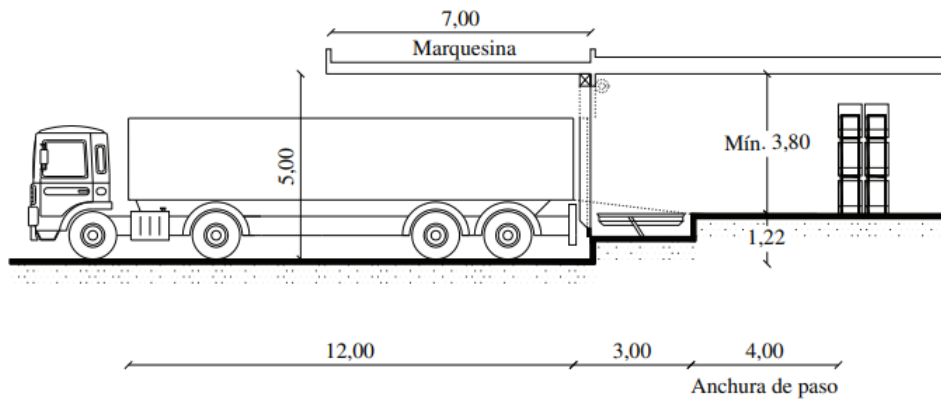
Dimensionament de Moll de Càrrega. Font: Disseny de Complexes Industrials
